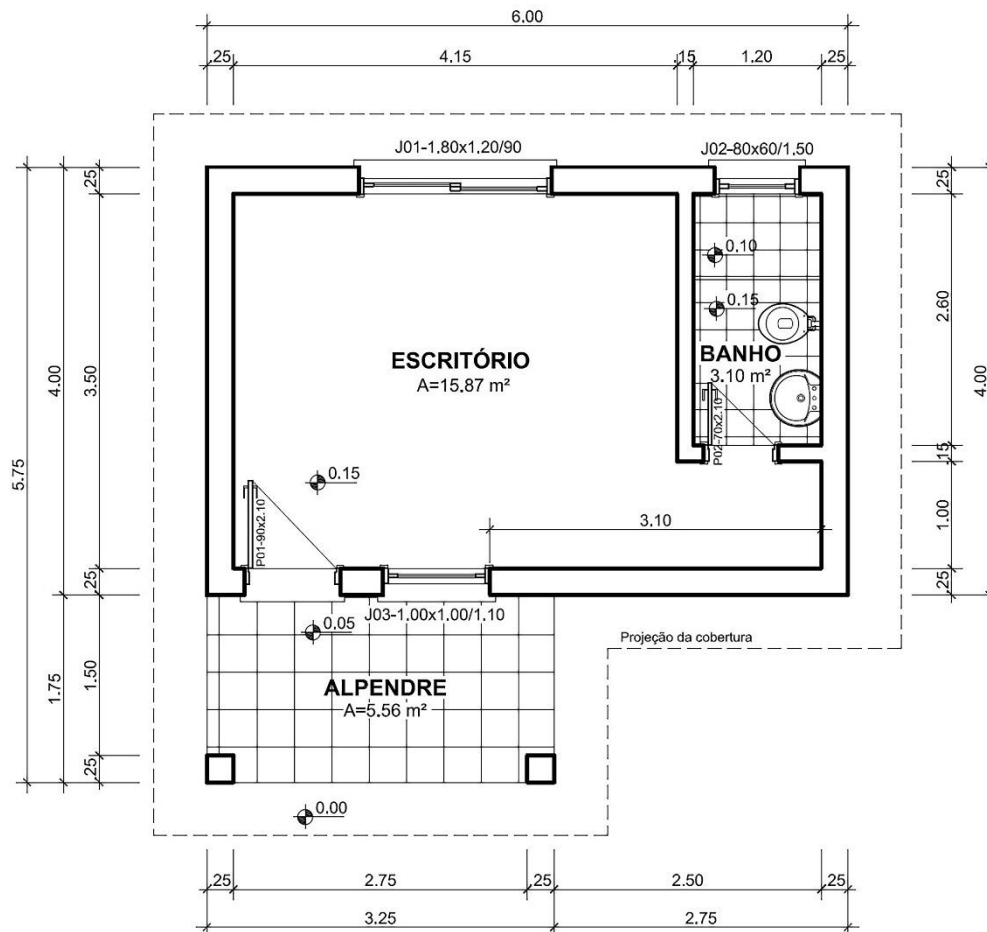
Exemplo de uma planta baixa cotada. Fonte: autor
